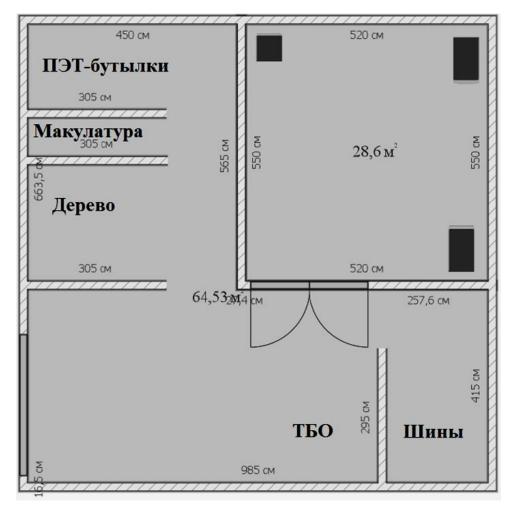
План площадки для временного хранения отходов и ангара для переработки В таблице 11 приведены данные расходов этому пункту.
